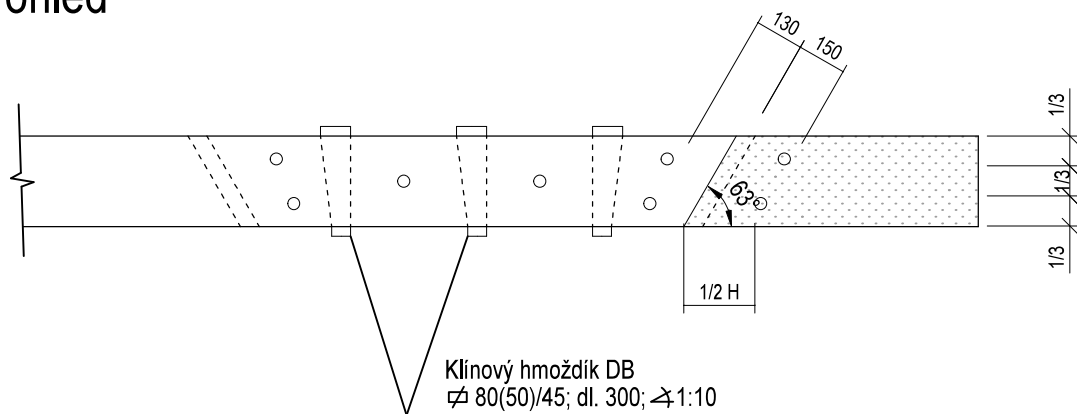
VAZNÝ TRÁM, STROPNÍ TRÁM
